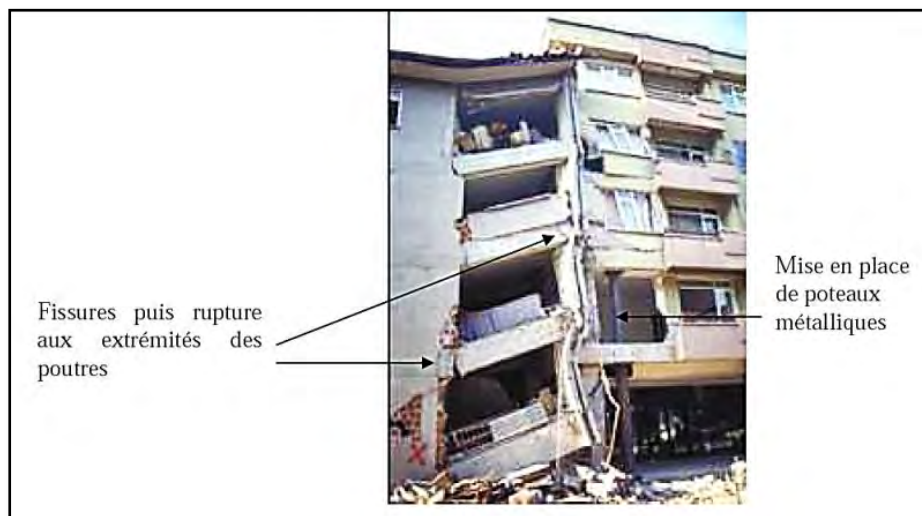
La destruction des éléments porteurs (poteaux ; poutres). Source : GARCIA JEAN-FRANÇOIS; 2007.
